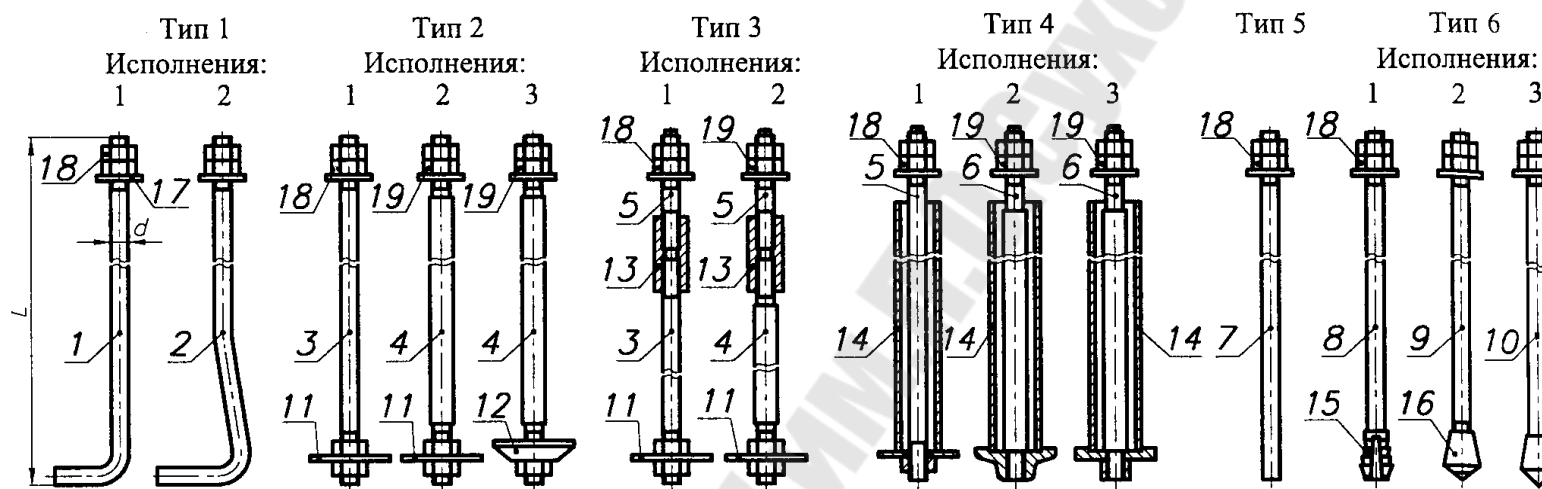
П.1 – Типы и конструкция фундаментных болтов: 1 – 10 – шпилька; 11, 12 – плита анкерная; 13 – муфта; 14 – анкерная арматура; 15 – цанга разжимная; 16 – втулка коническая; 17 – шайба; 18 – гайка по ГОСТ 5915 – 70; 19 – гайка по ГОСТ 10605 – 72
